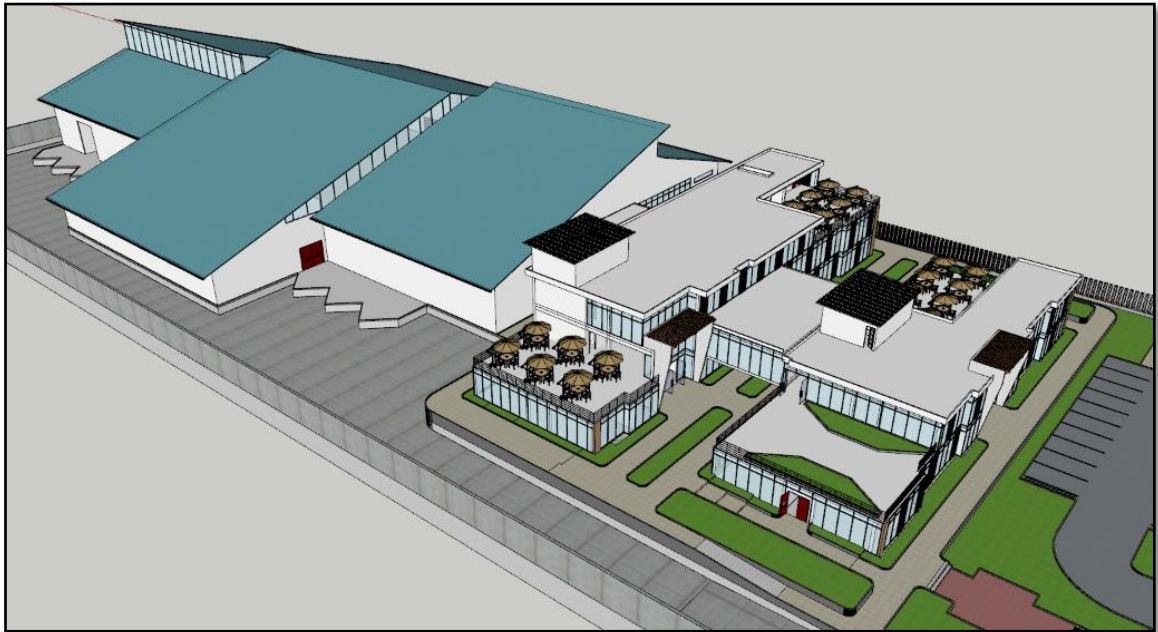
Vista tridimensional de la planta de Frutas y Verduras.
